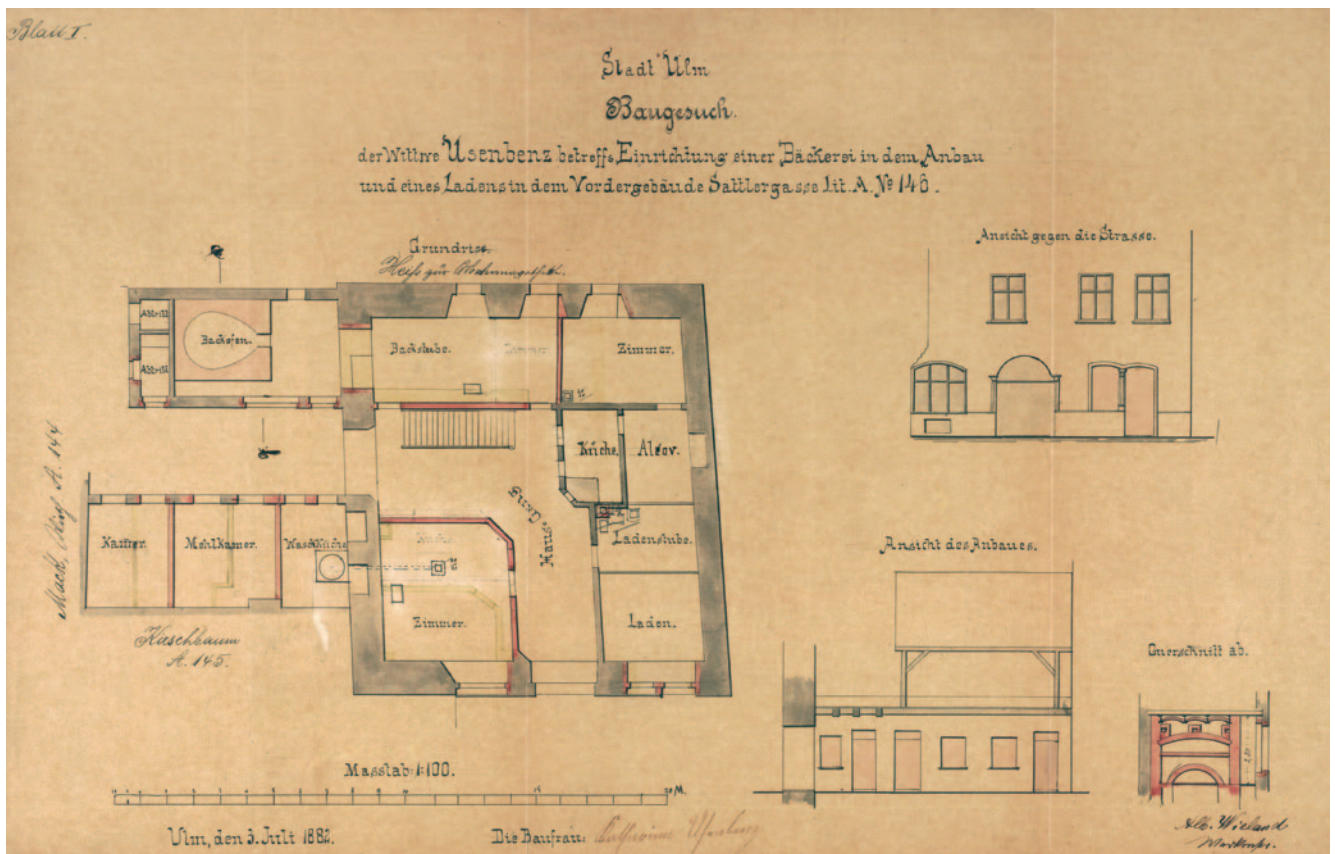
Gebäude Sattlergasse 9 (A 146), Erdgeschossgrundriss, Erstellung eines Backofens im Anbau und eines Ladens im Vordergebäude, Baugesuch 1882.
